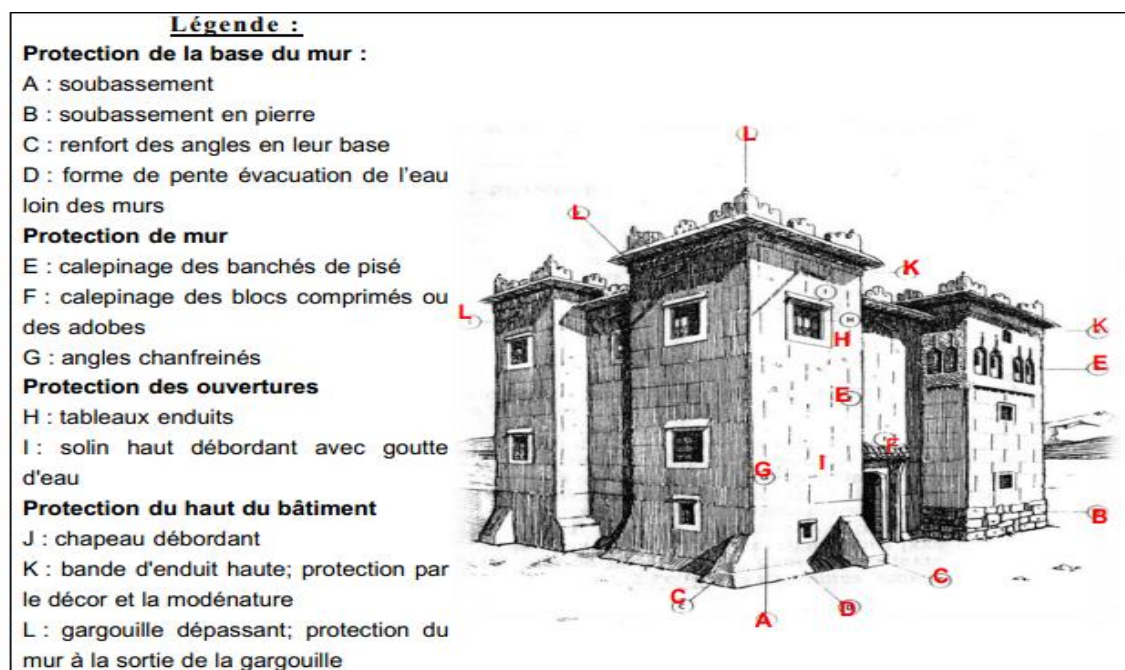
Le schéma de bonne conception architecturale d'un bâtiment en terre (source le CRA Terre)
